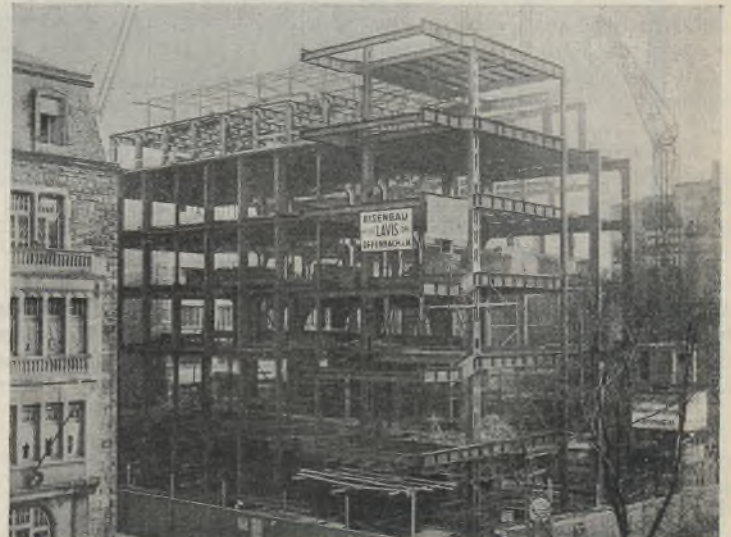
Turmkonstruktion mit den anschließenden Frontflügeln.
